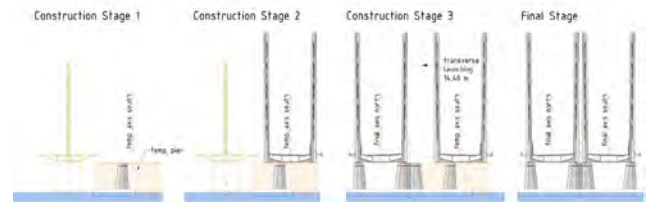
Proceso constructivo: ripado transversal del puente completo (LAP).
